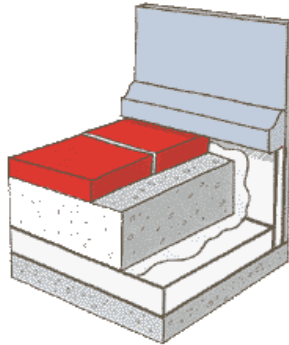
Isolamento sob pavimento flutuante [26]
